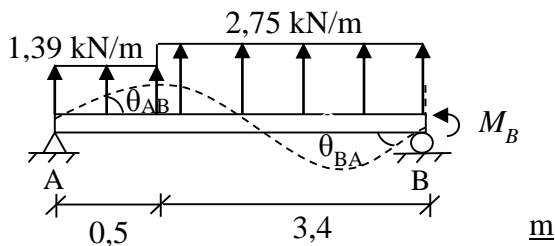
Verkande vindlast på takbalk i zon F och G.
